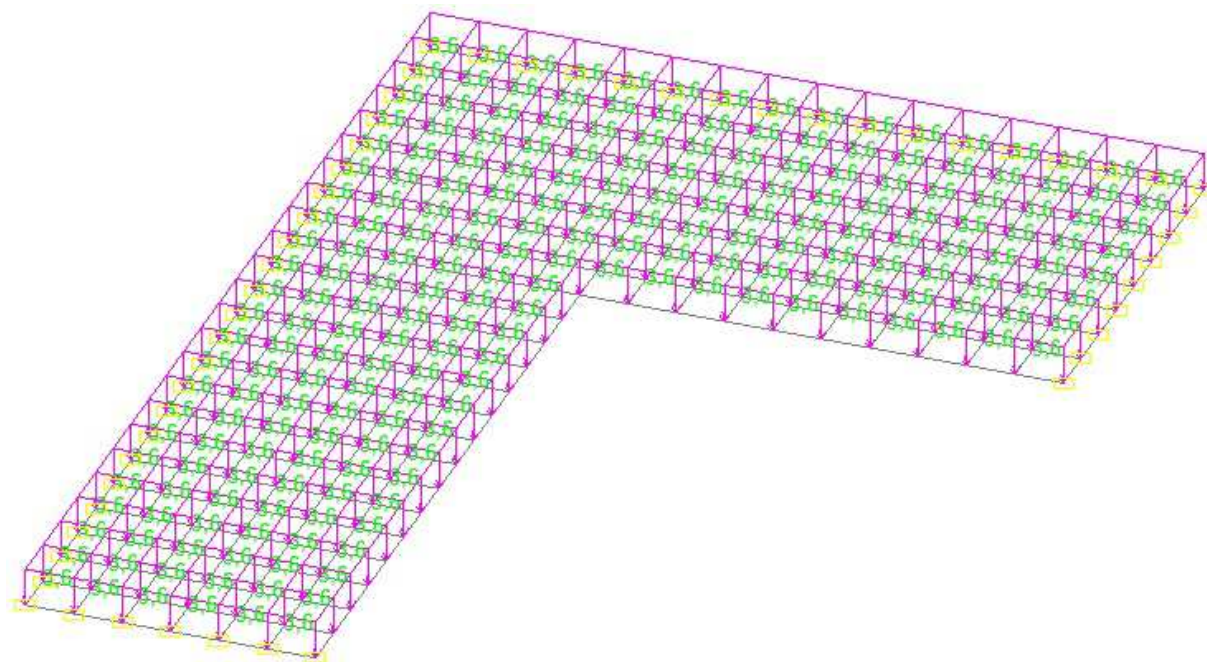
Схема загрузки плиты кратковременной нагрузкой
